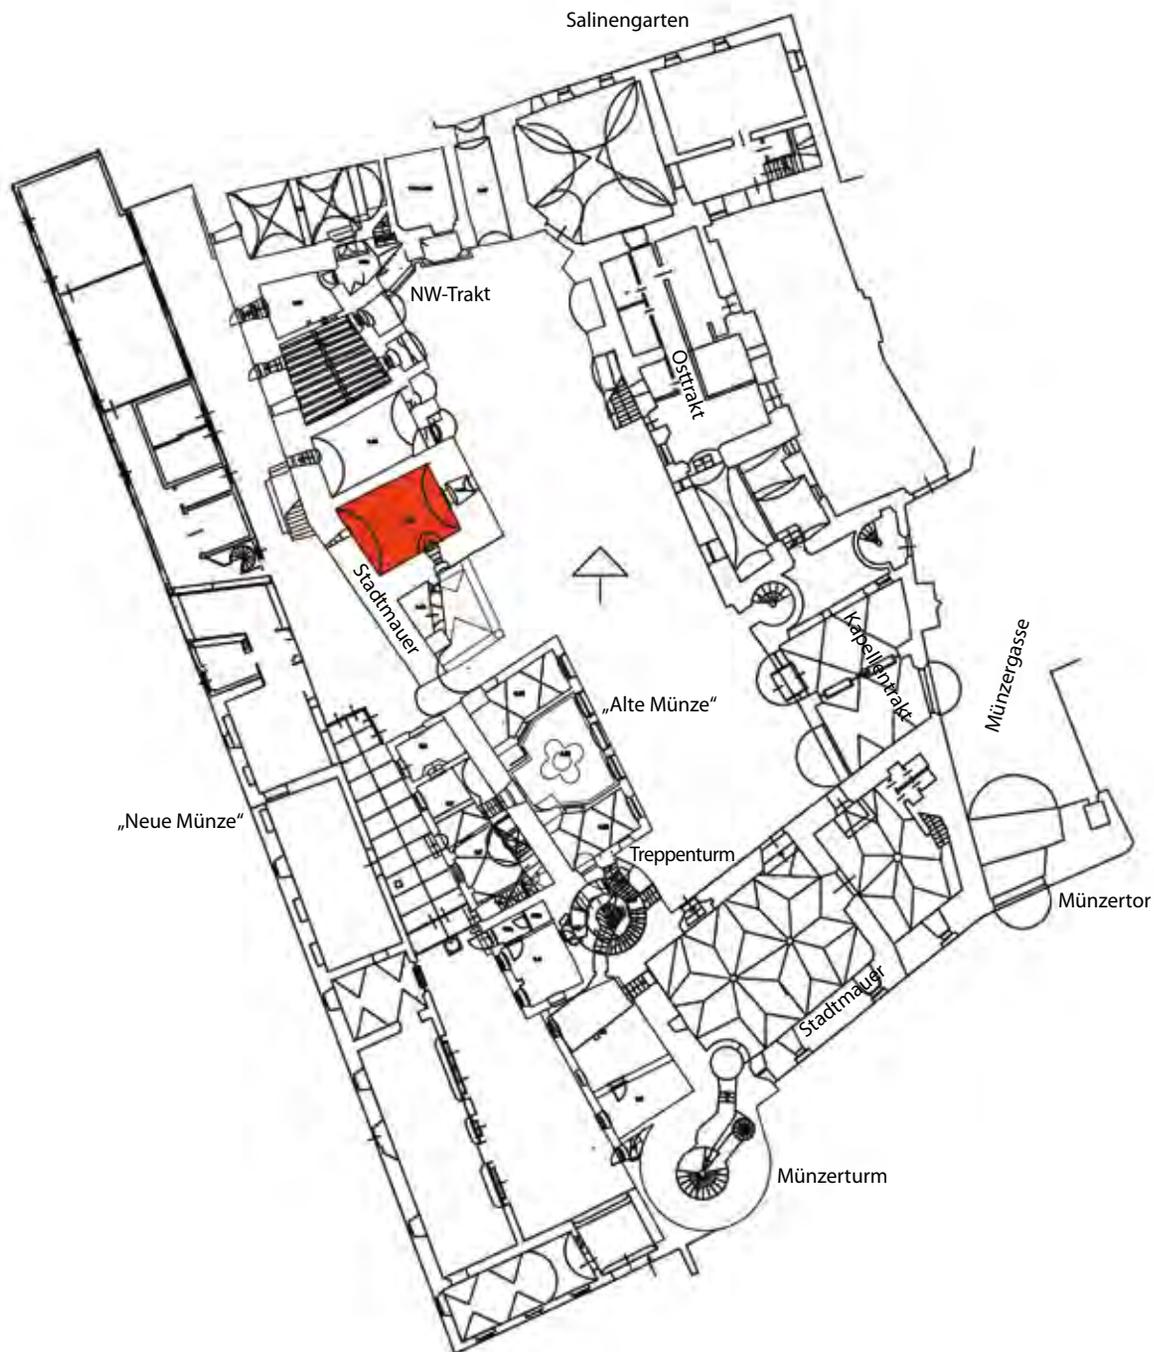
Burg Hasegg. Grundriss des Erdgeschosses, rot eingefärbt der Raum 1.17, in dem die bisher umfangreichsten archäologischen Untersuchungen stattfanden. M 1:500. Grundlage: Arch. B. Gratl, Innsbruck, ergänzende Bauaufnahmen (Westtrakt): A. Zanesco.
